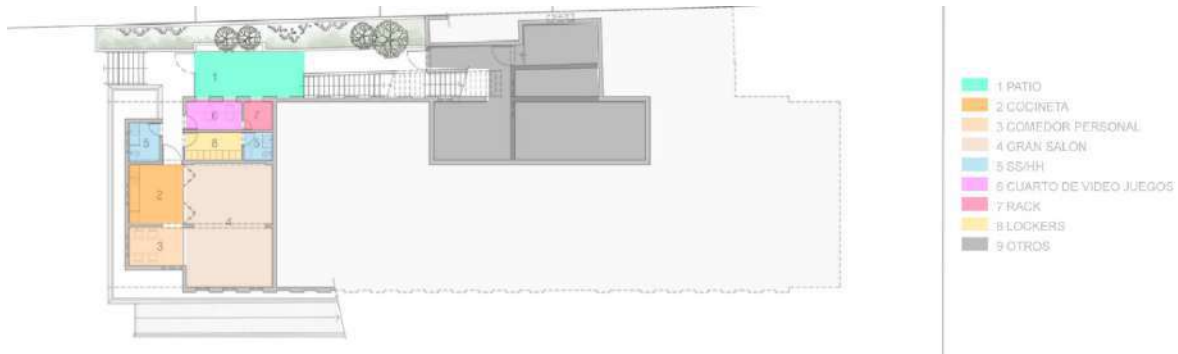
Planta nivel -1 Plaza Biblioteca Comunitaria la Molina
